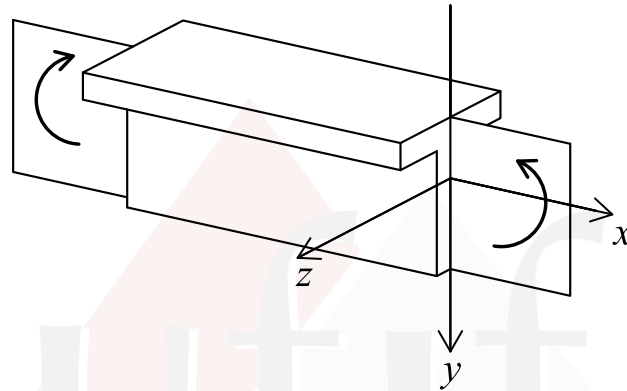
Viga T em flexão reta - Plano de Solicitação vertical
